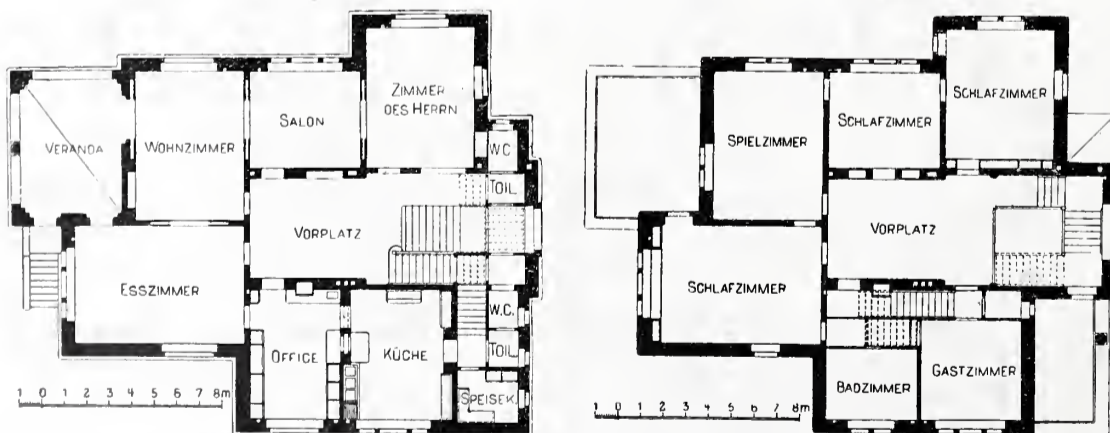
Grundrisse vom Erdgeschoss und I. Obergeschoss der Villa E. Huber-Stockar in Zürich V. — Masstab 1 : 400.
